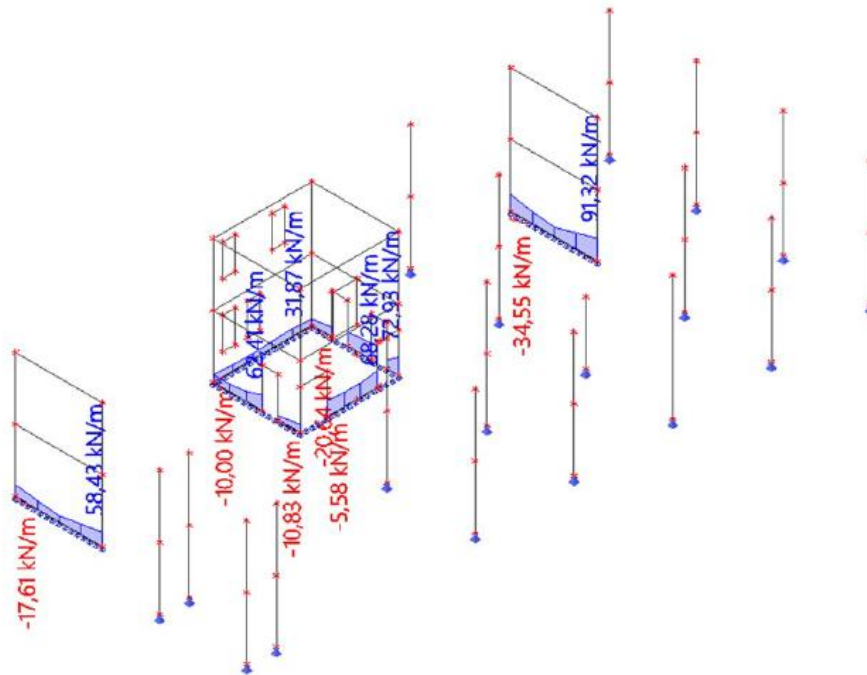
půdorys 1.NP konstrukčního systému – model A
